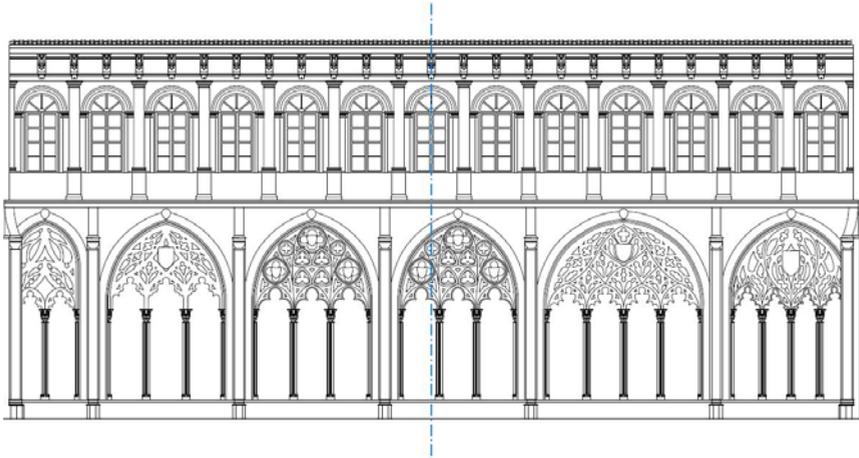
Alzado Este del Claustro Mayor. 2016. Plano del autor
